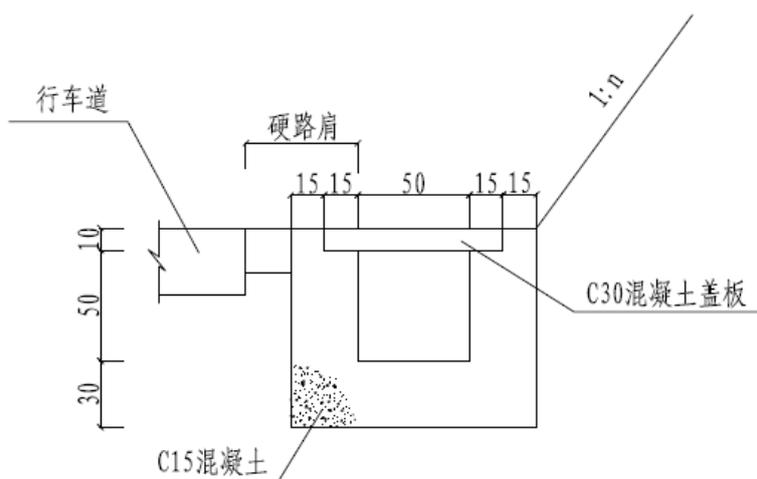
钢筋混凝土盖板边沟典型断面图
